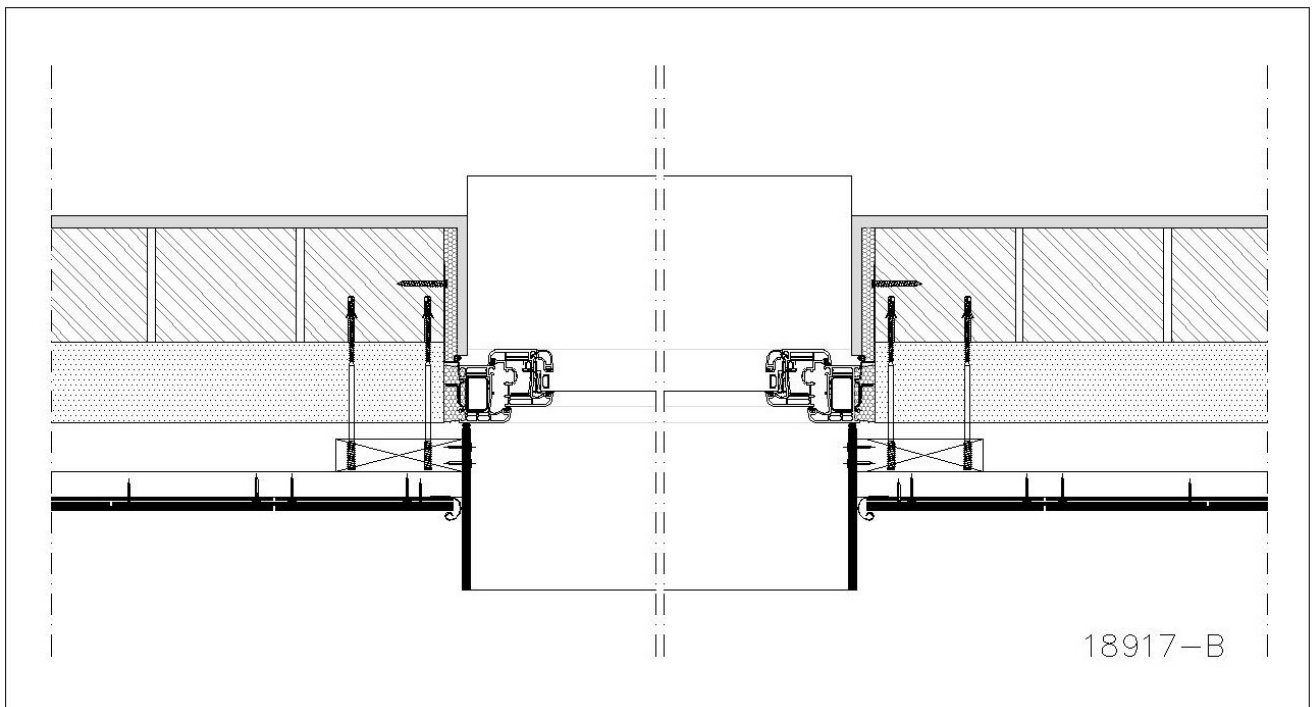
Voorbeeld inspringend raam (met uitspringende dagkant) – horizontale doorsnede
